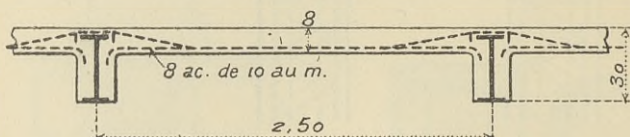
Plancher avec poutrelles en fer et hourdis, système Koenen.
